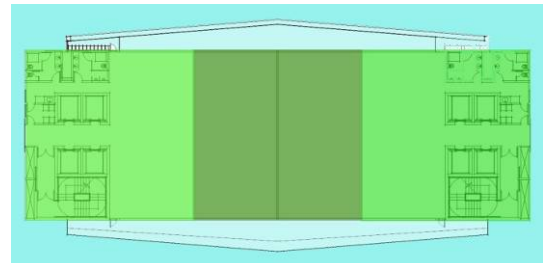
Esquema da proporção, em planta, de 3:1.
